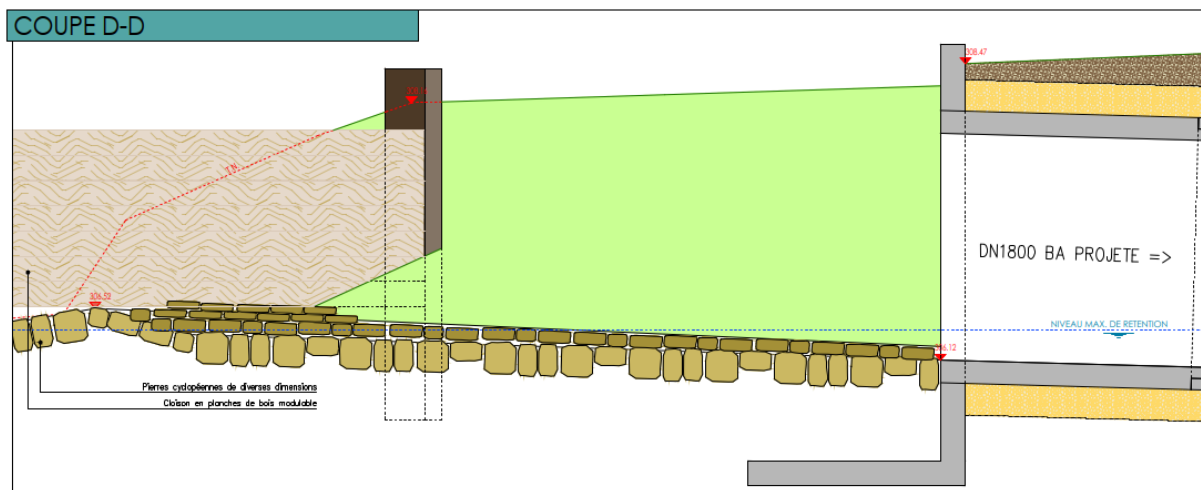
Auszug aus dem veralteten Plan „Concept d'assainissement - Vues en plan et coupes ouvrages“ (Quelle: Luxplan S.A. Stand 06/2020): Querschnitt durch die Ausleitung (Schnitt DD, vgl. Abb. 24)
